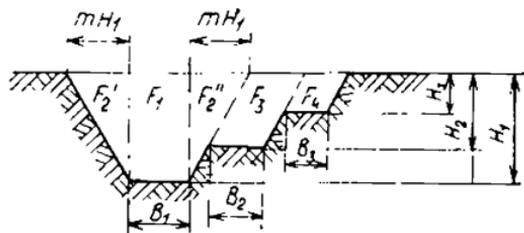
Сечение траншеи для раздельной прокладки газопровода.
